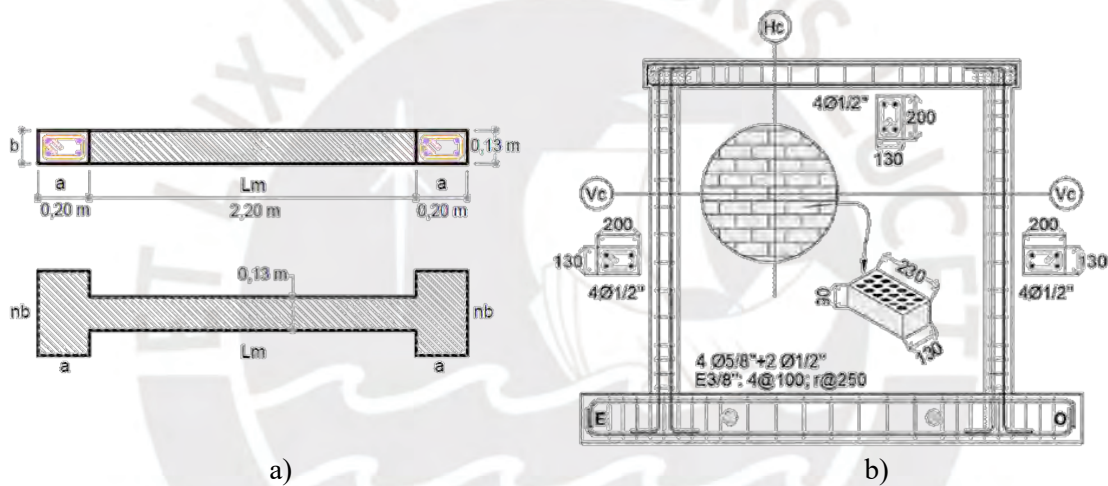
Geometría del muro ensayado, a) Vista en planta sección bruta y transformada, b) Elevación y detalle de refuerzo [19].
